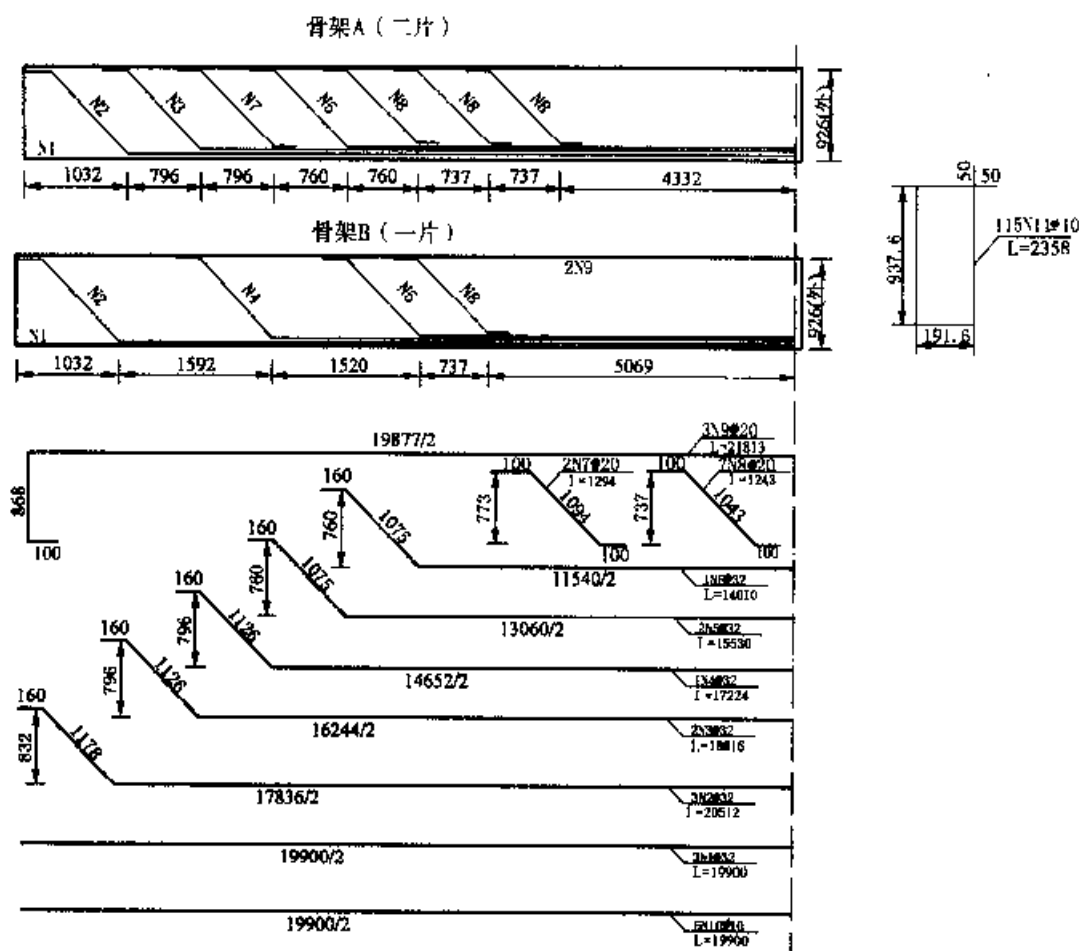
钢筋骨架及钢筋详图(尺寸单位:mm)
